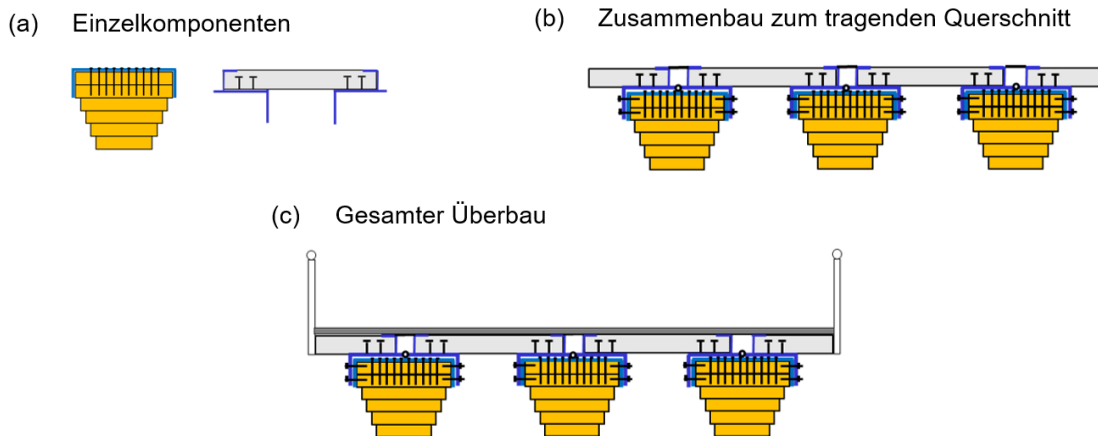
Idee für eine Holz-Beton-Verbundkonstruktion mit demontabler Betonplatte
